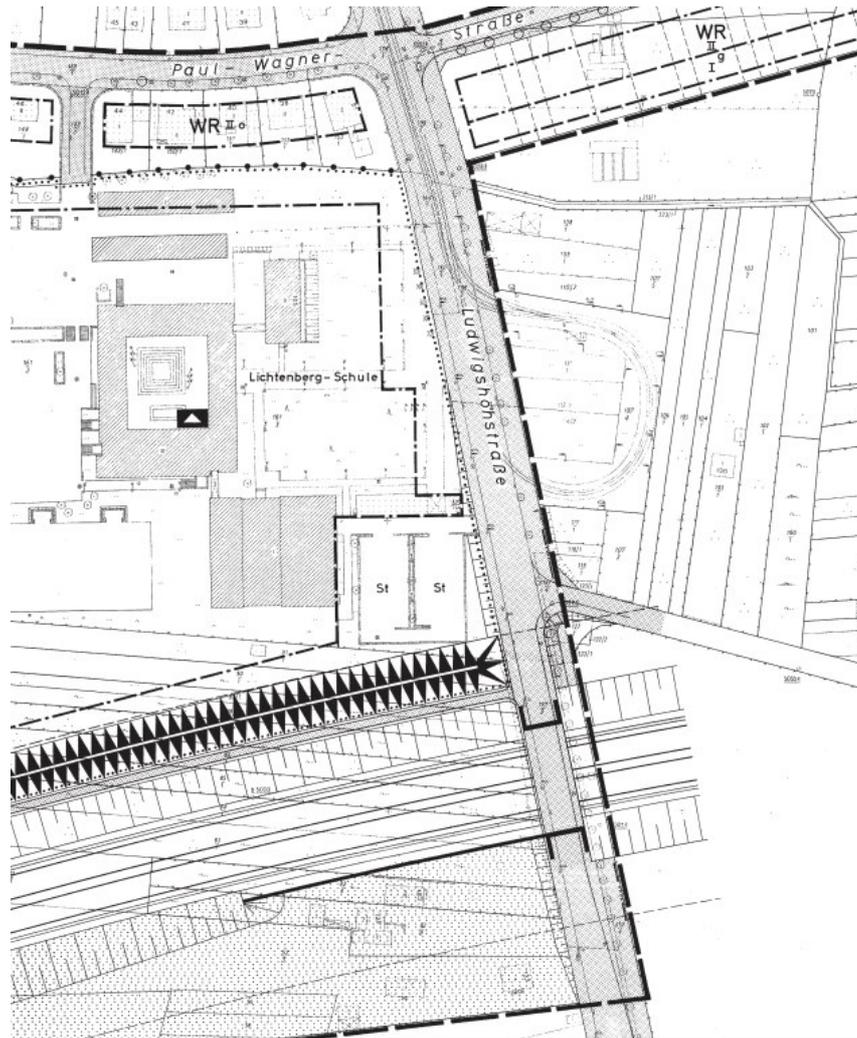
Ausschnitt des Bebauungsplan S 12 mit festgesetzter öffentlicher Verkehrsfläche im Bereich der Ludwigshöhstraße (ohne Maßstab) (Stadt Darmstadt, 1975).
